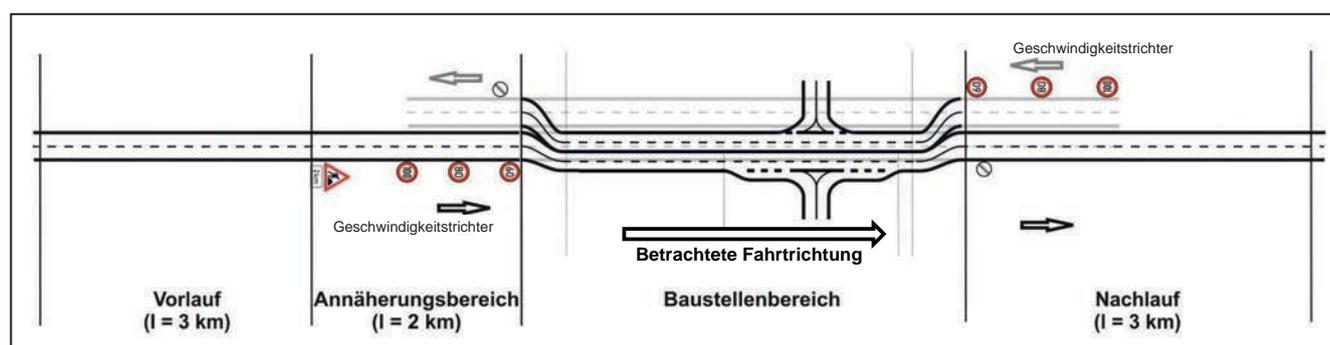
Einteilung Autobahnabschnitt mit Baustellenbereich (richtungsgetrennte Betrachtung)
